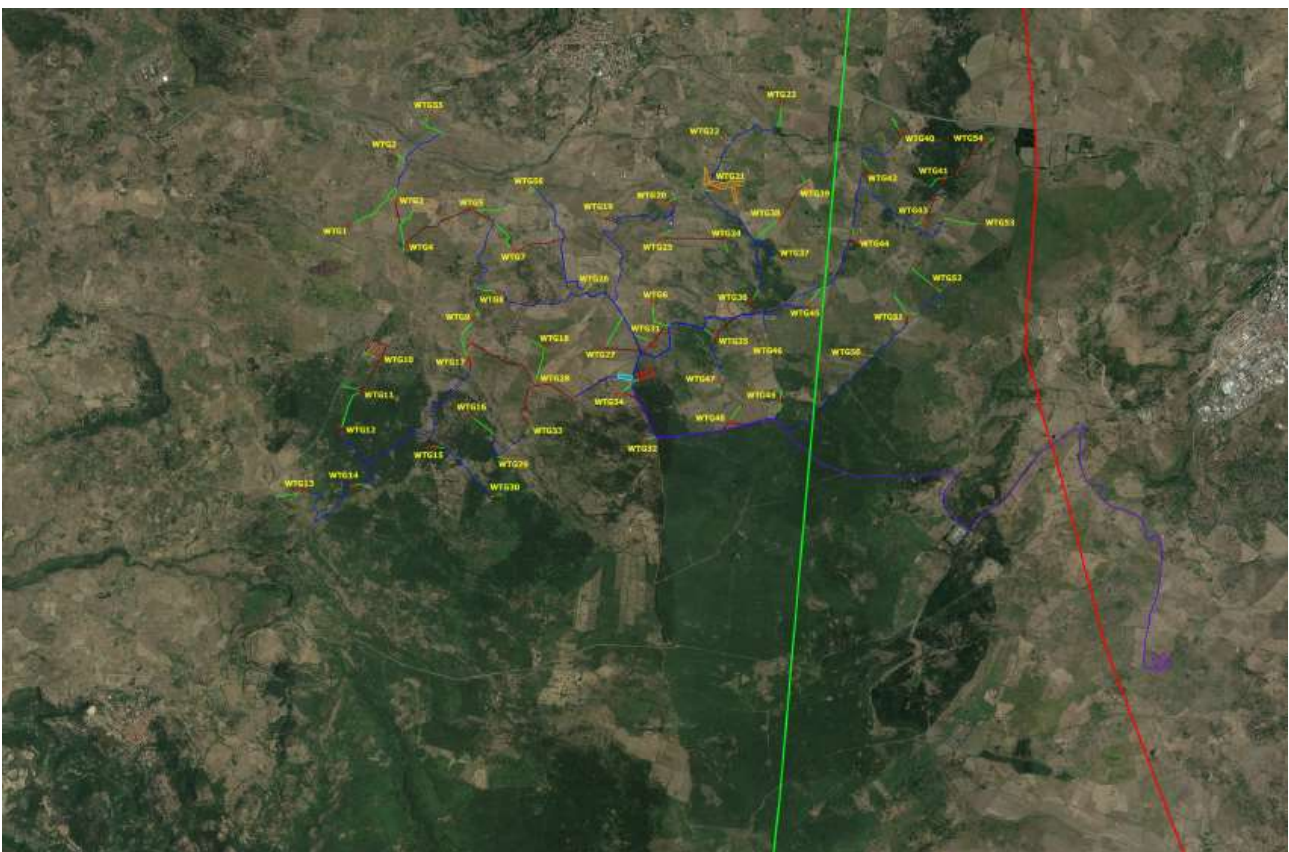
Estratto della Tav.03 Layout impianto su ortofoto
